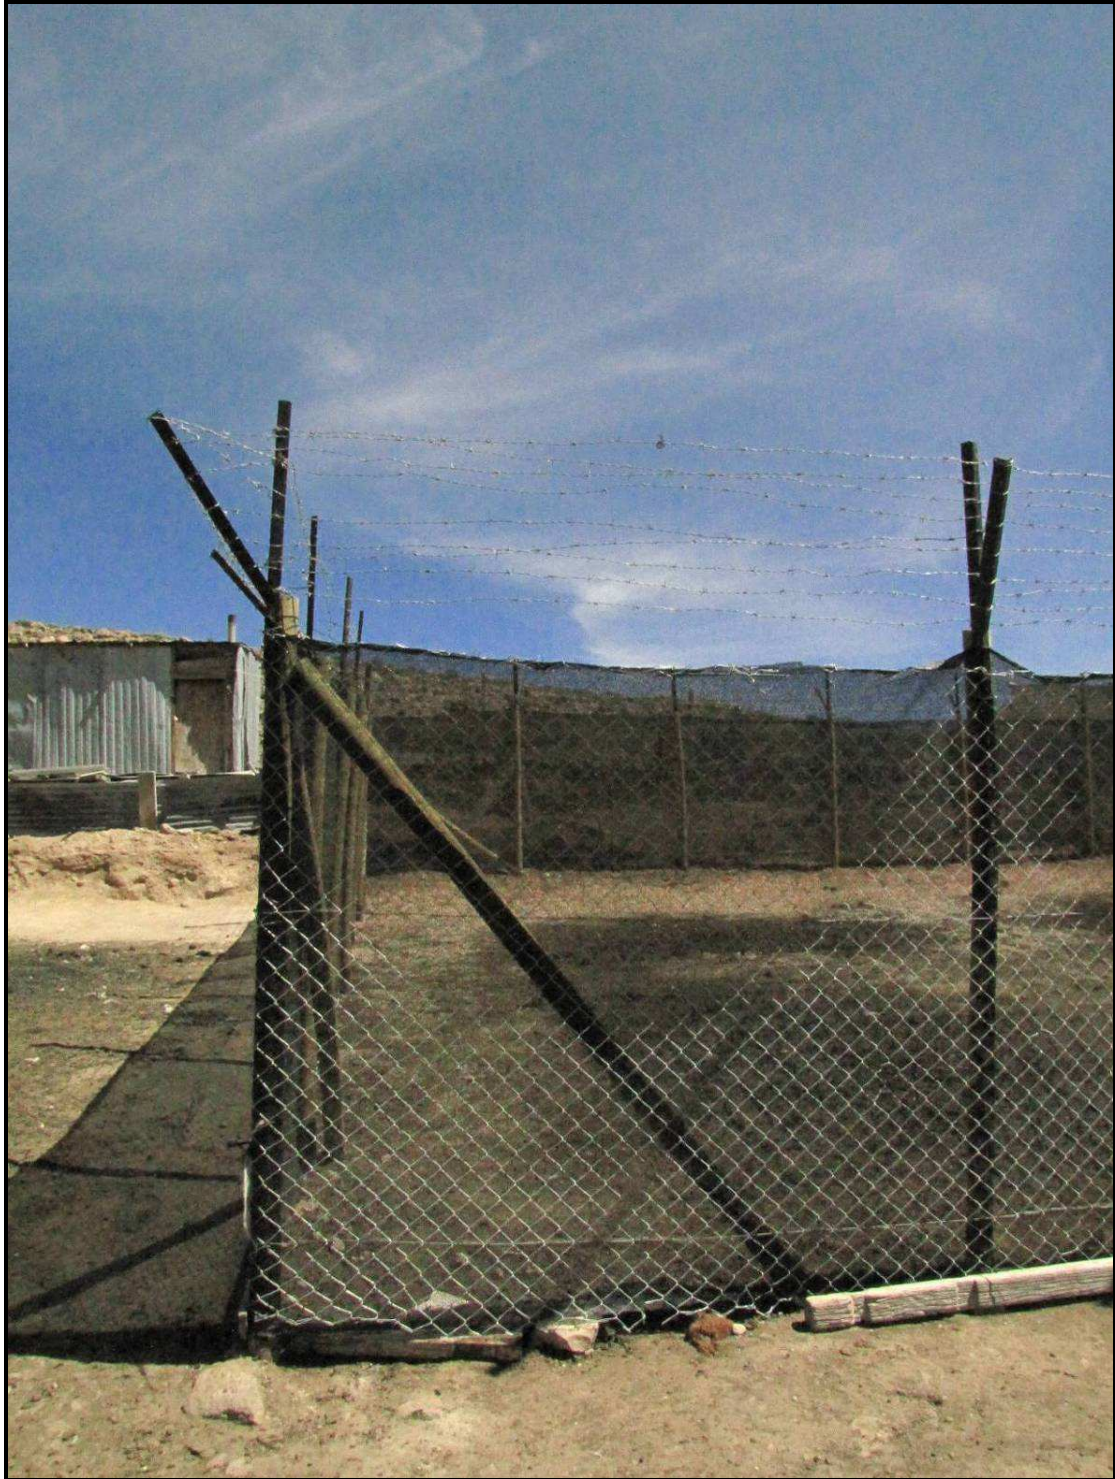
y 36. Detalle de la puerta y protecciones del corral.
